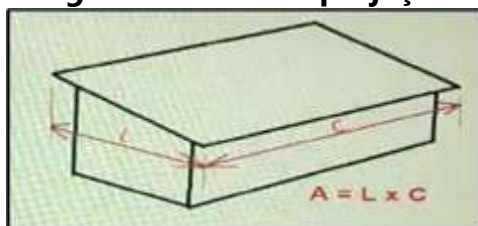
Telhado do Pavilhão 1 do CEHMA.
